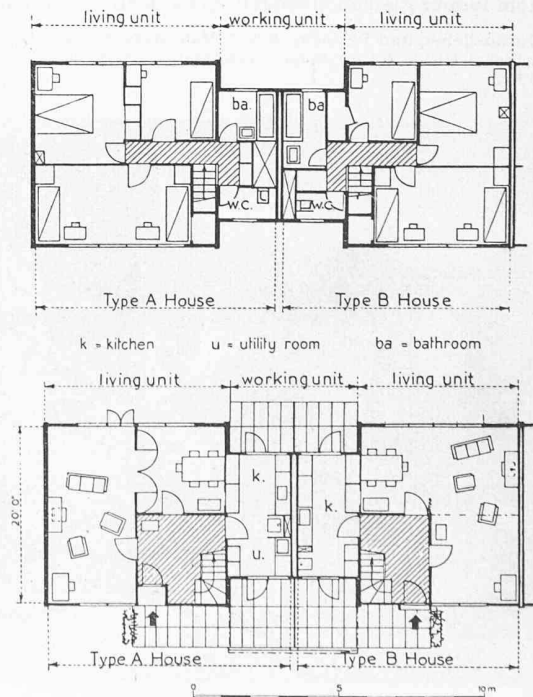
Howard-Haus, Erdgeschoss und Obergeschoss 1 : 250. Utility room = Putz-, Heiz-, Wasch- und Abstellraum
